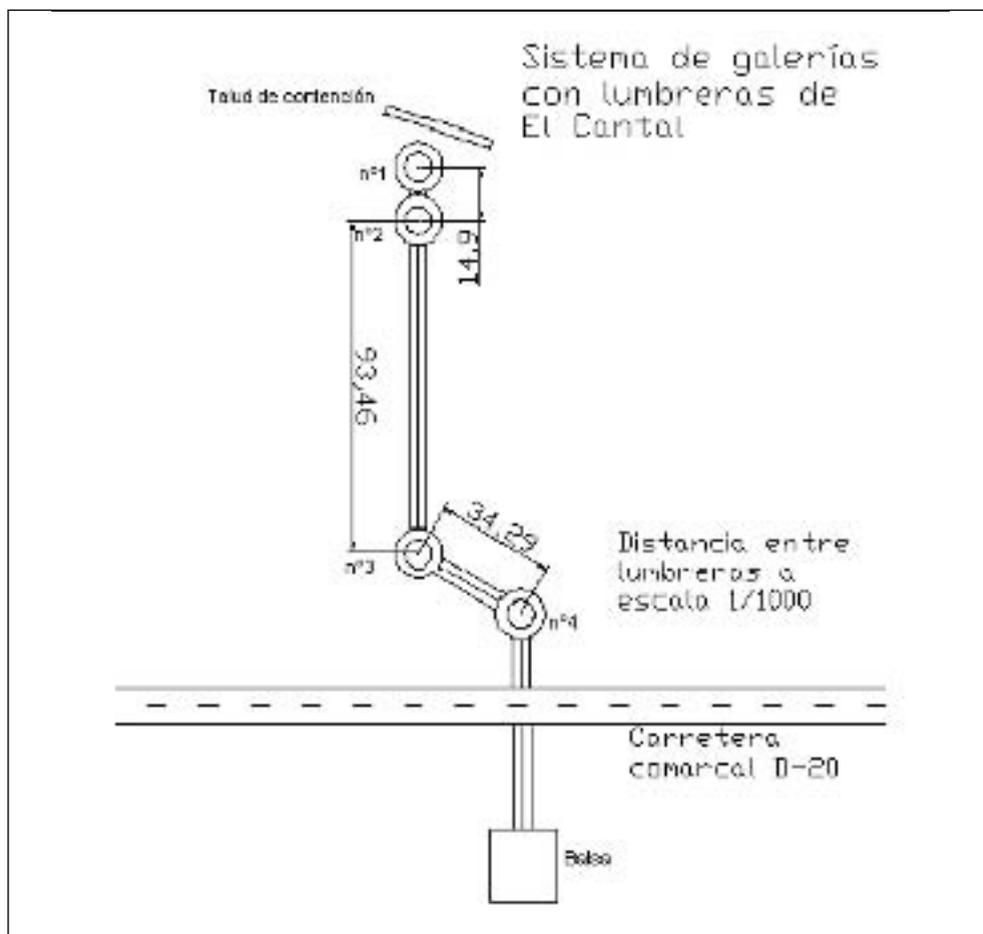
Perfil en planta del sistema de galería con lumbreras de El Cantar.
